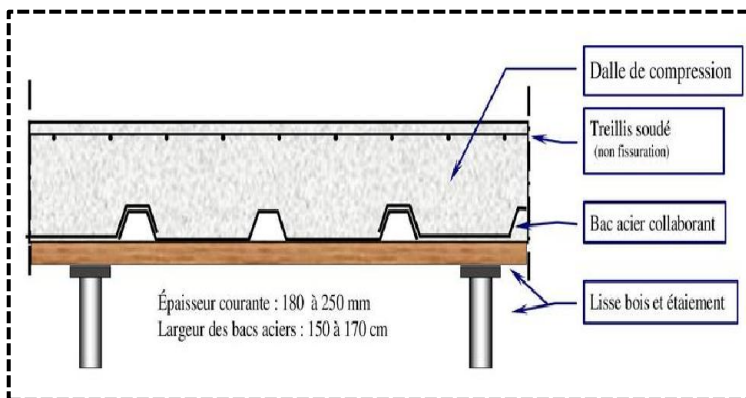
coupe sur le plancher collaborant ; source :slidechare site.
